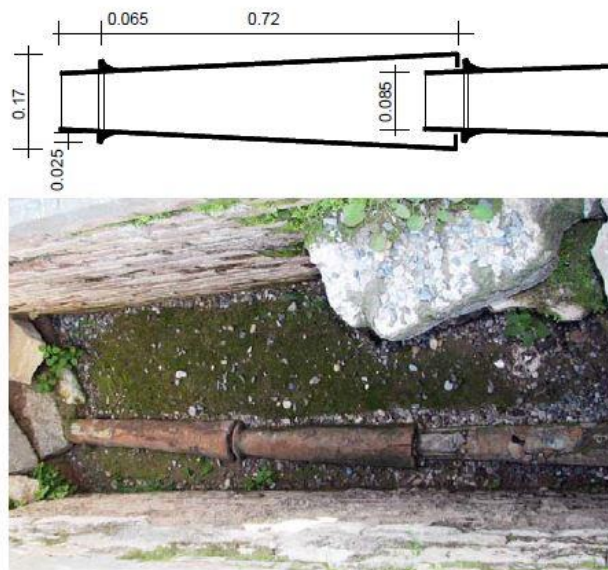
Condutas de abastecimento de água em terracota. [2]
